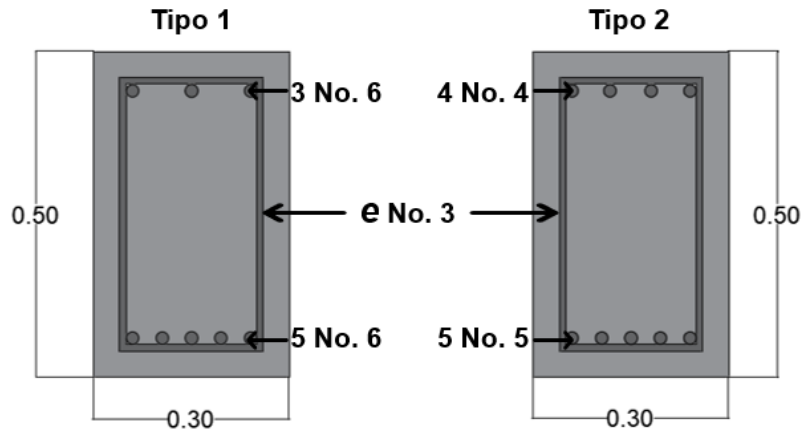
Tipologías de secciones transversales para vigas del bloque A, el detalle de todos los cálculos se encuentra en el Apéndice H.
